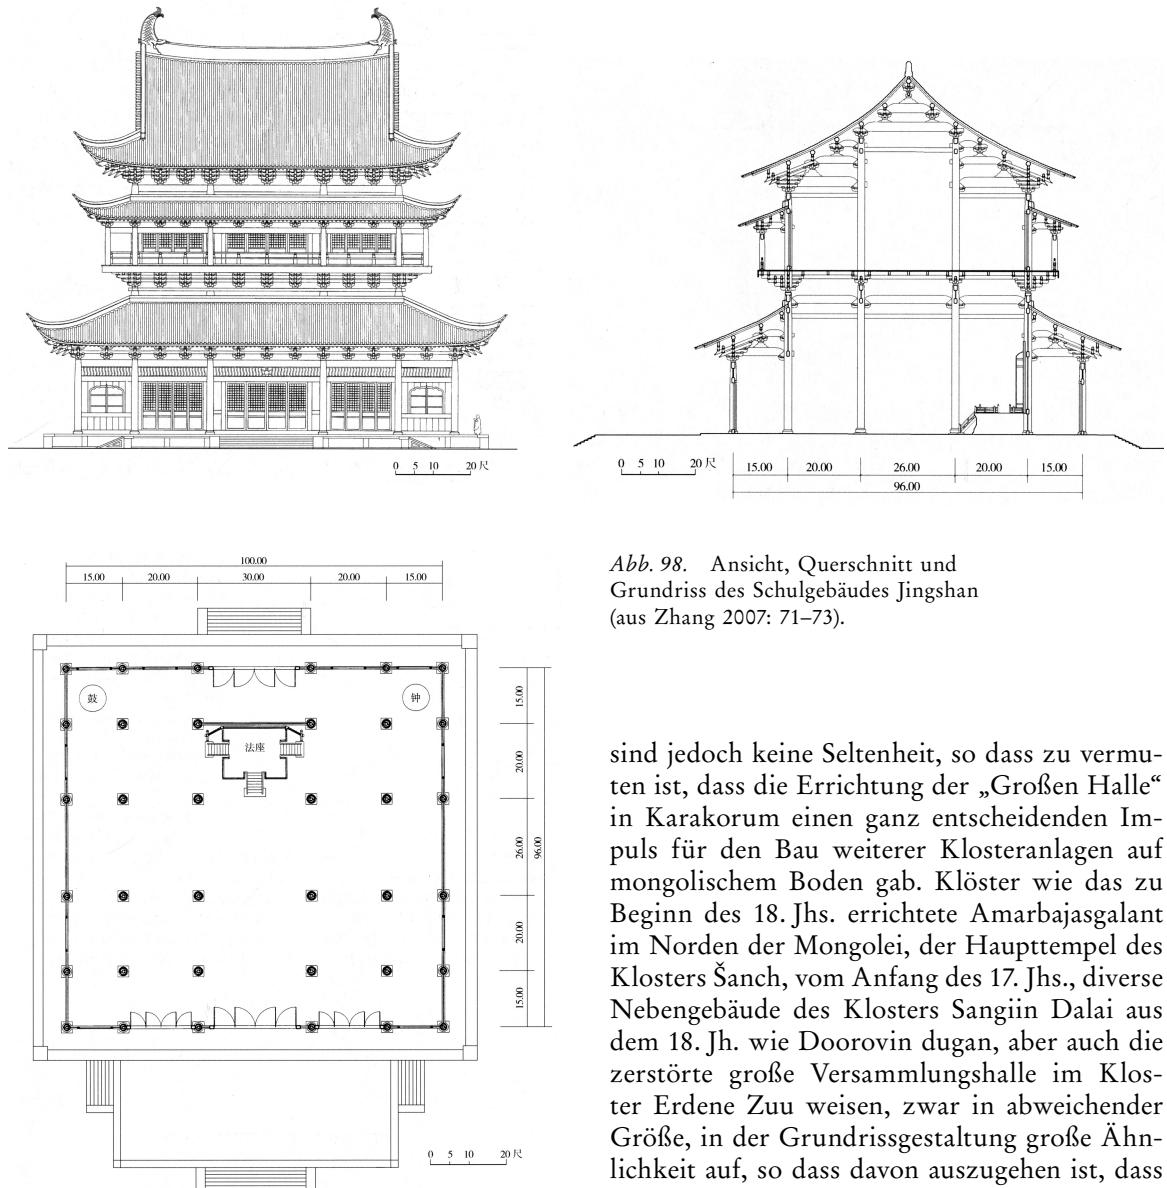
Ansicht, Querschnitt und Grundriss des Schulgebäudes Jingshan (aus Zhang 2007: 71–73).
